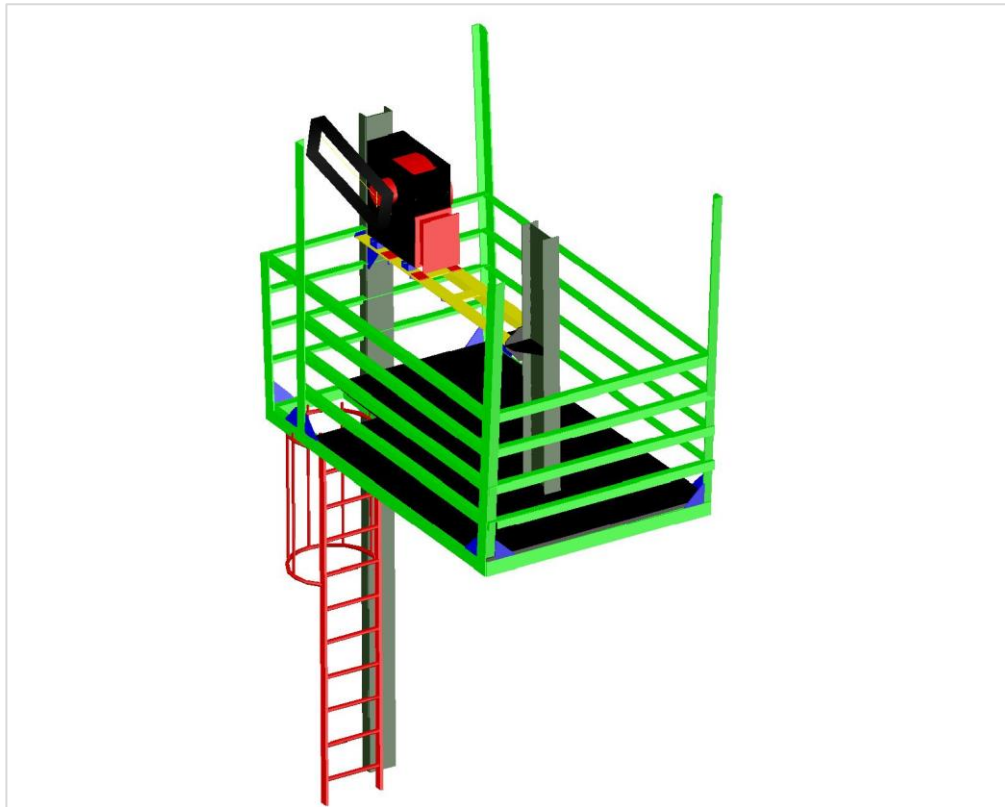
Площадка вентилятора НСВ84060В
